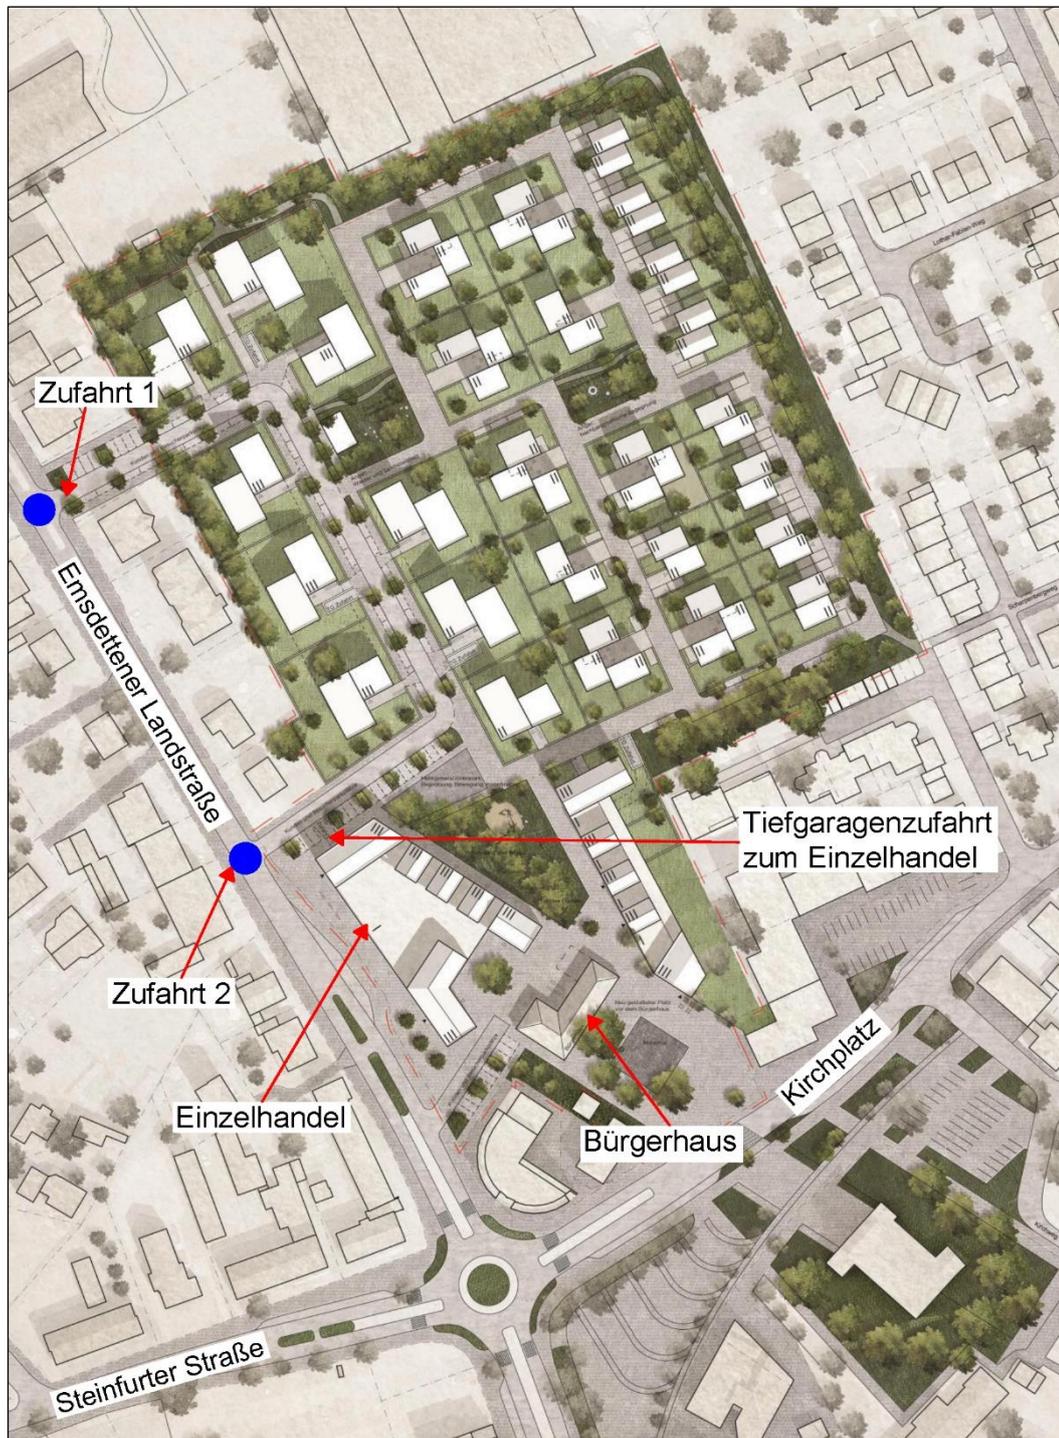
Zufahrten und geplante Bebauung (Quelle: Stadt Greven)
